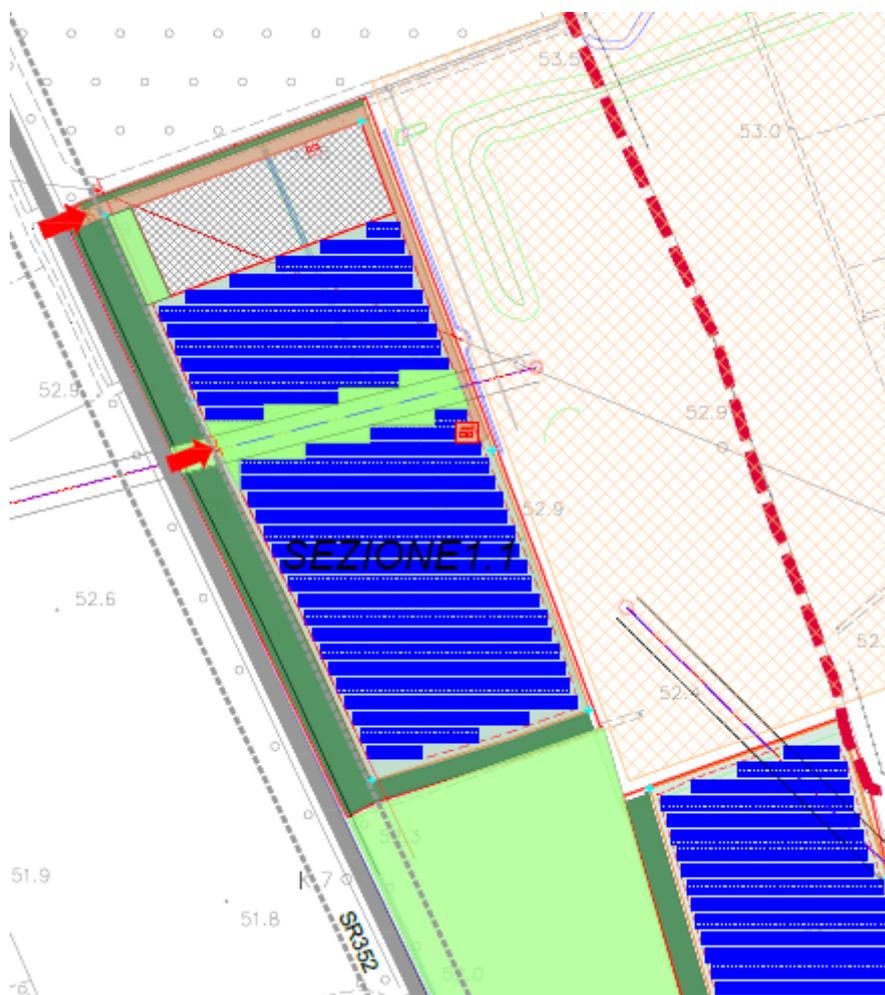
Planimetria del parco fotovoltaico con localizzazione dell'area in cui dovrà sorgere la stazione
